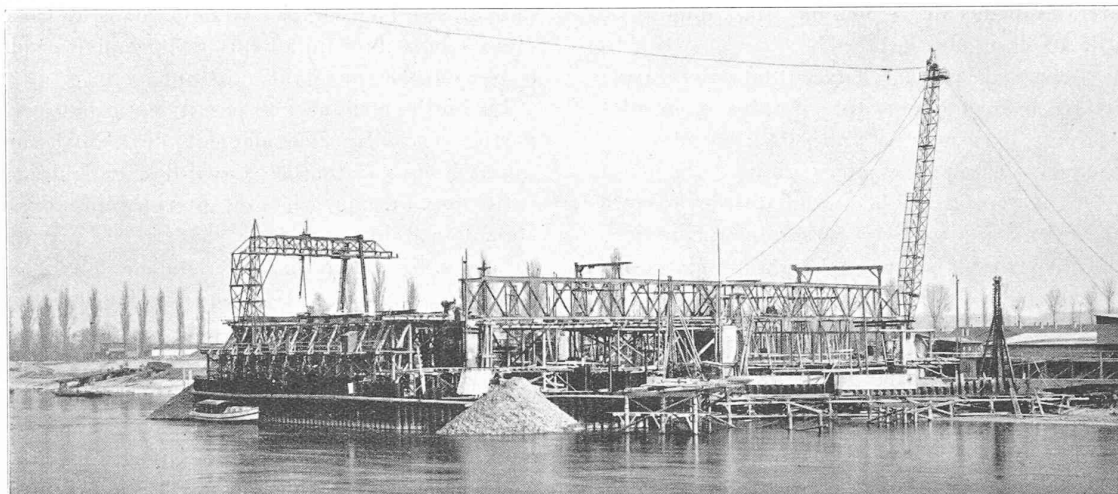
Travaux de la rive droite du Rhin, au début de 1930. — A gauche : Echafaudage du caisson de la pile III.
